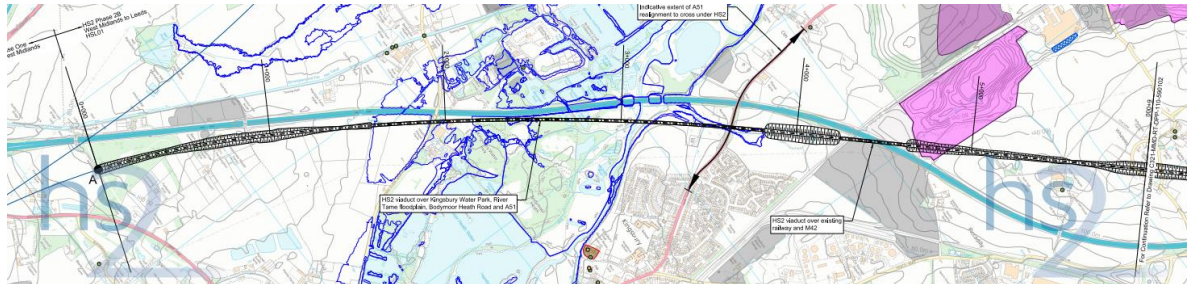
Planta do traçado viaduto sobre Kingsbury Water Park e Zona de inundação do Rio Tame (Unido, HS2 Phase 2b: Marston to Birchmoor route sheet 1).
